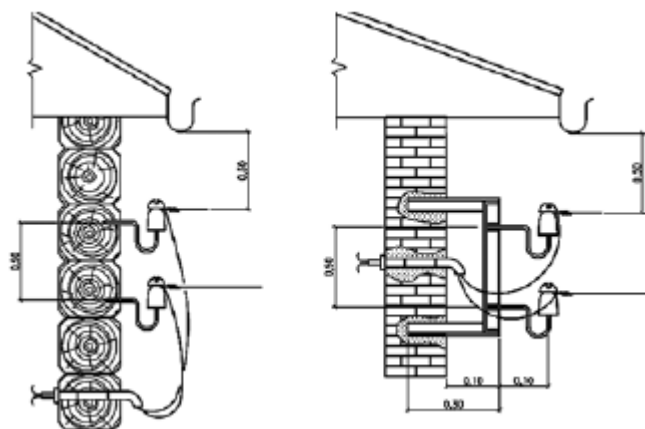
Крепление изолятора ввода на деревянной и каменной стенах
